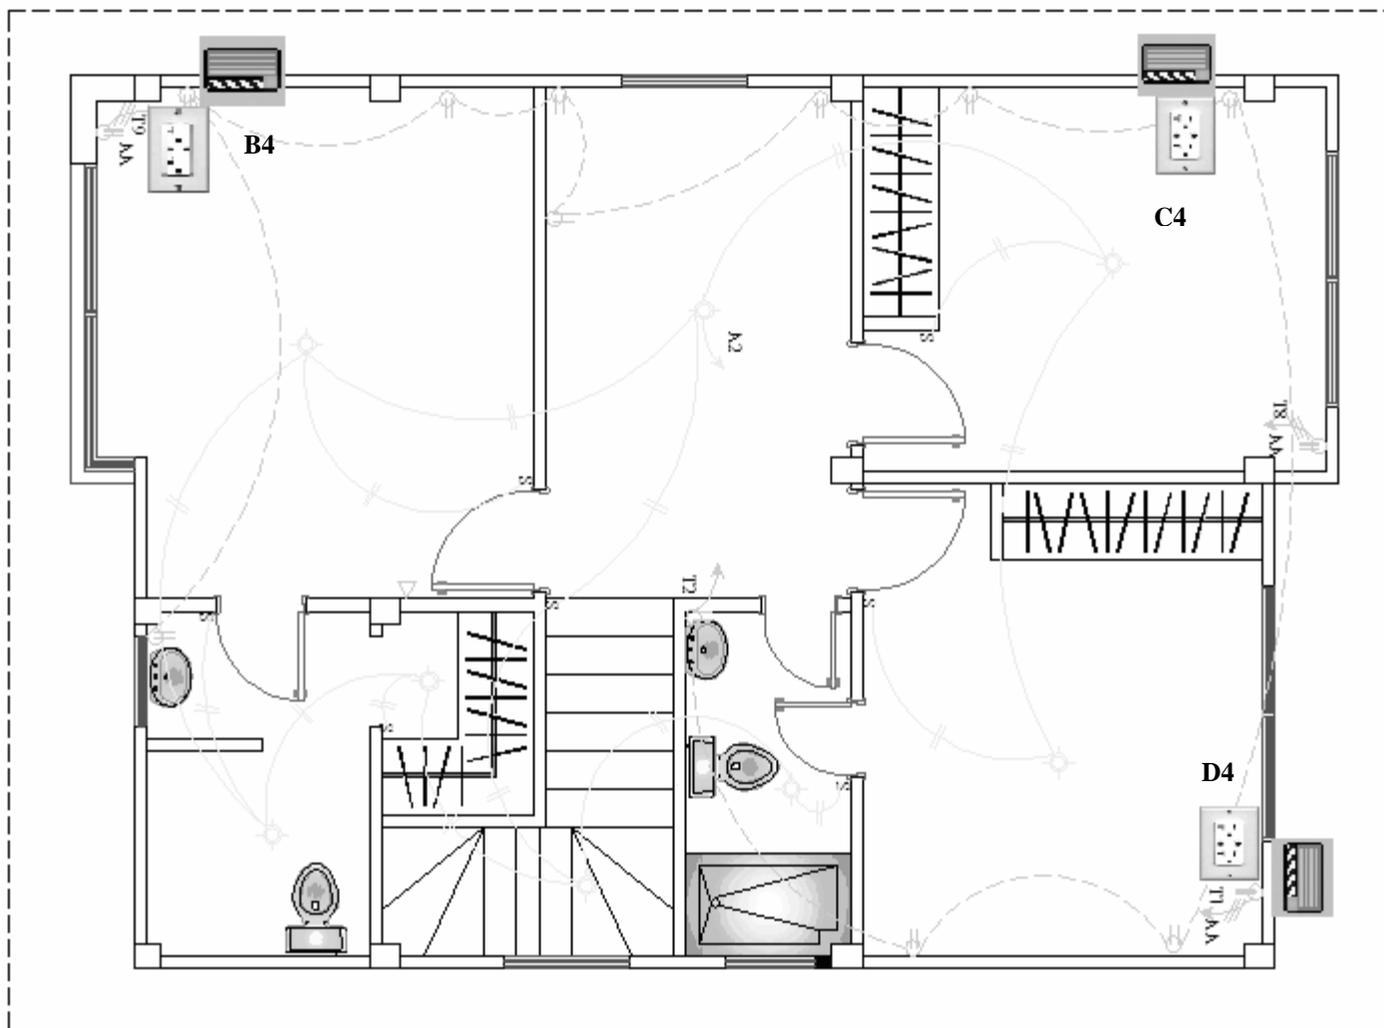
Sistema de Climatización, Planta Alta, Plano Eléctrico.
